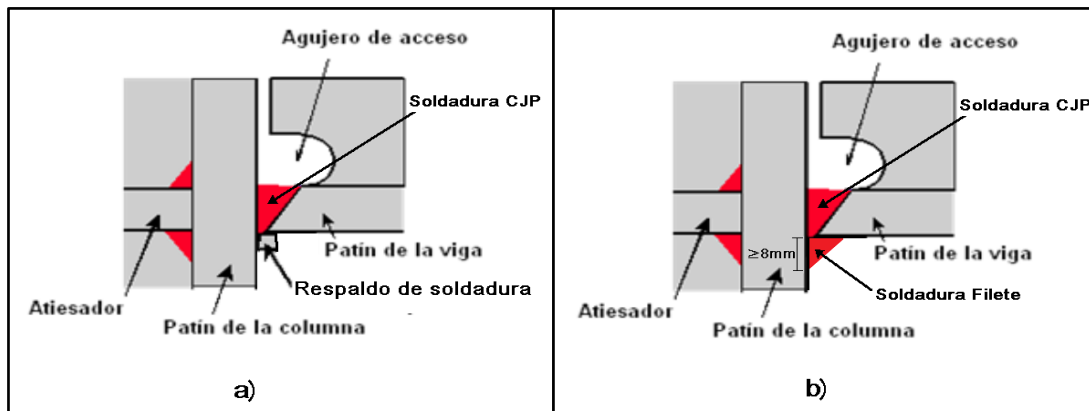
Soldadura en el patín inferior de la viga. a) Patín con placa de respaldo; b) Patín con soldadura filete.
